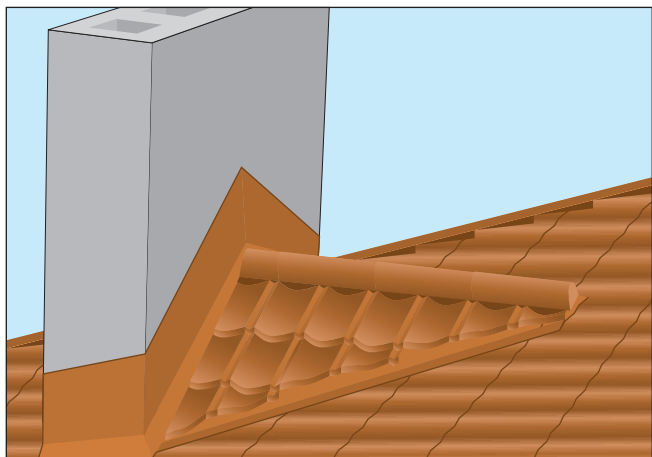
Еще один вариант примыкания кровли к трубе (см. рис. 108)
